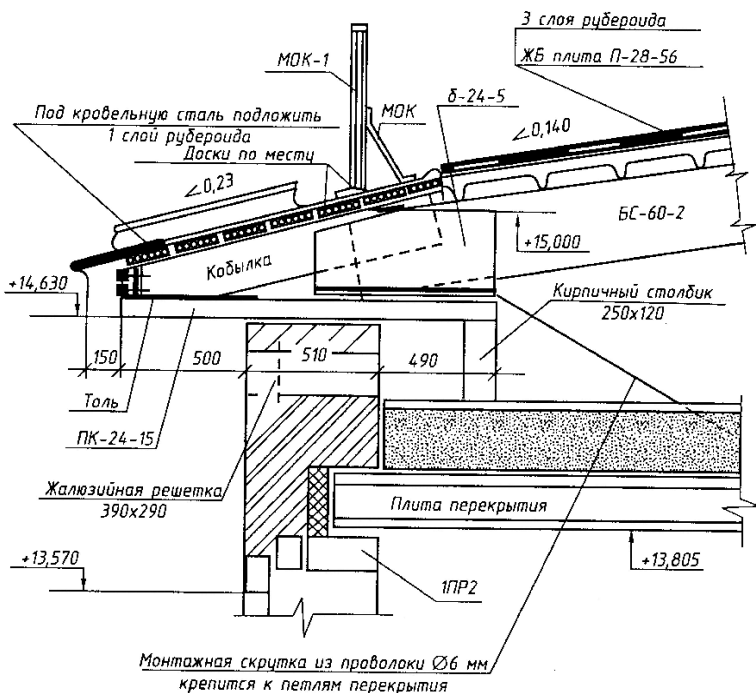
Пример обозначений материалов в узле опирания кровли на стену
